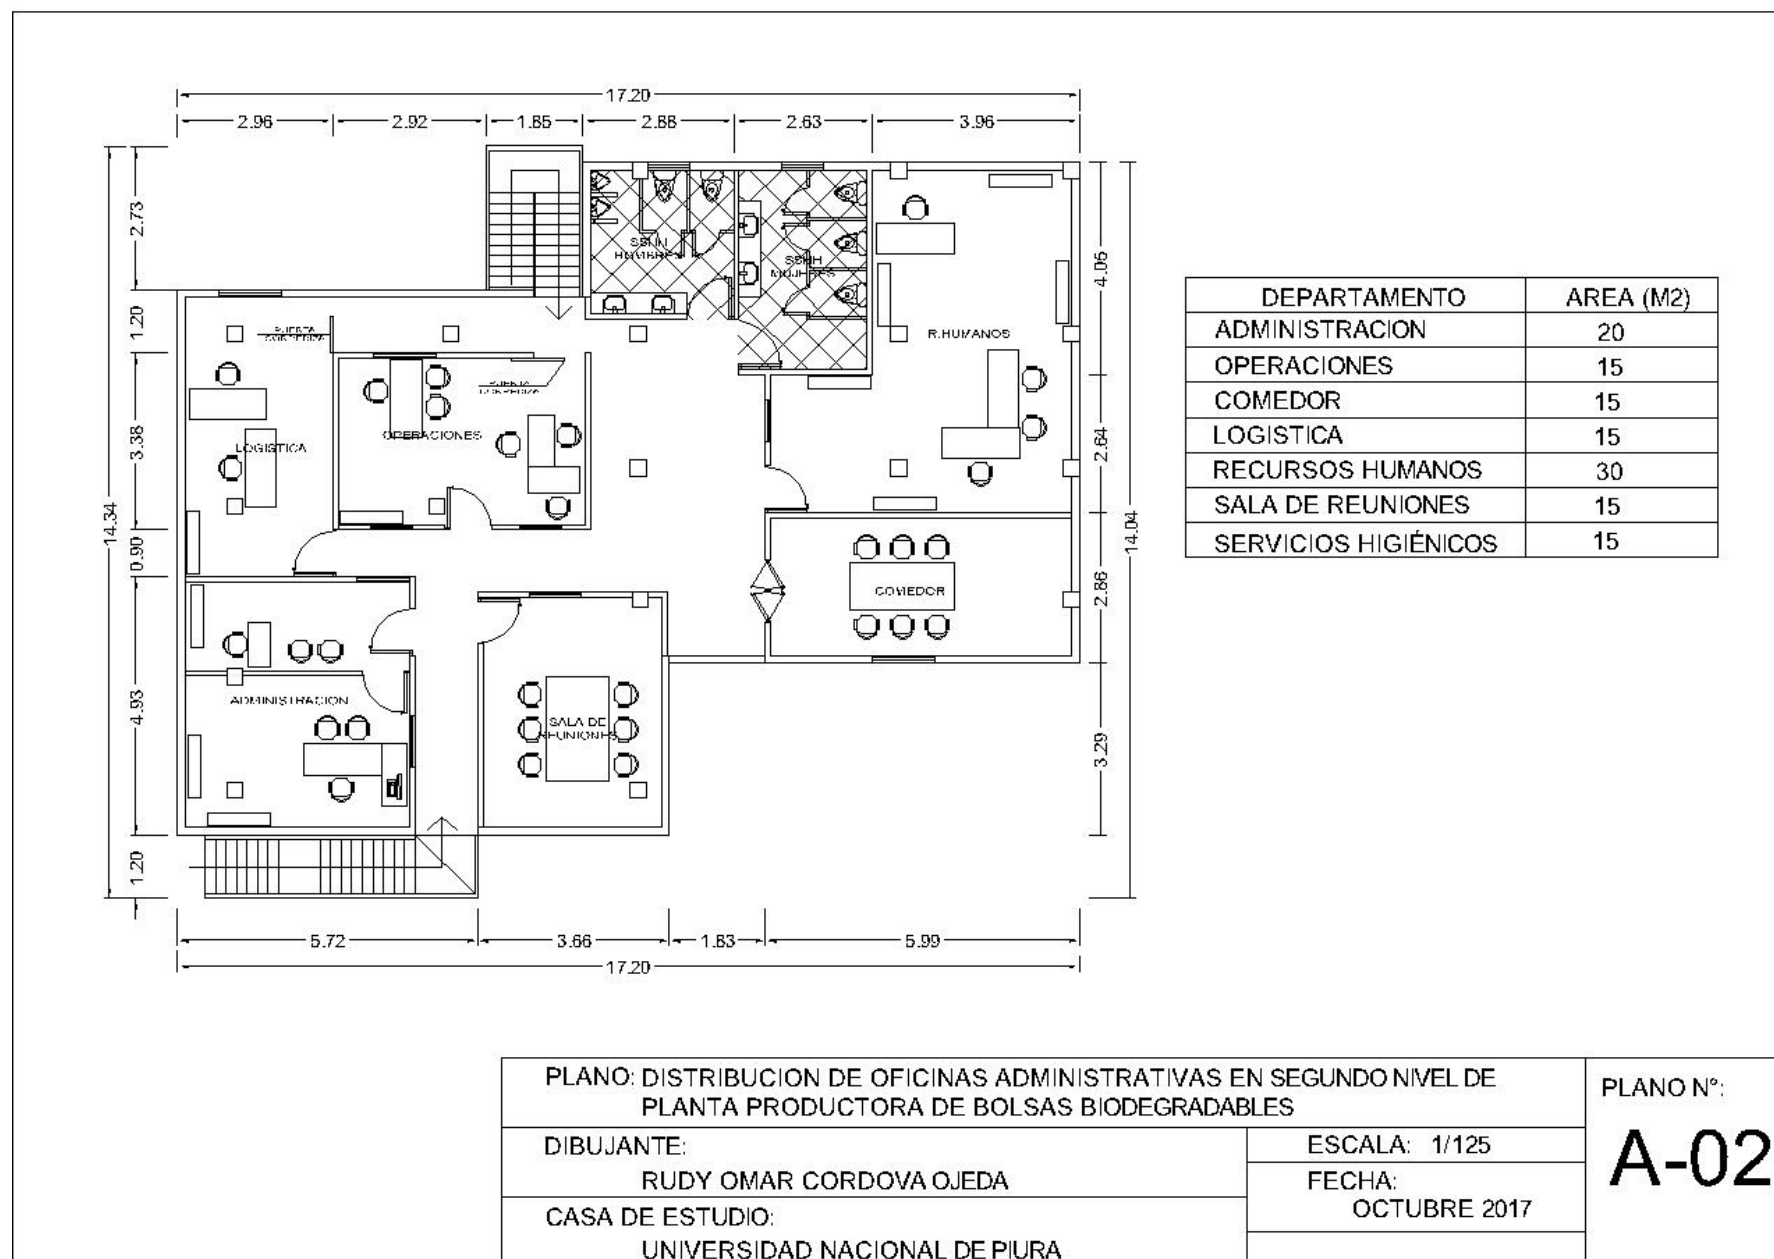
Distribución de áreas en Planta – Segundo Nivel
